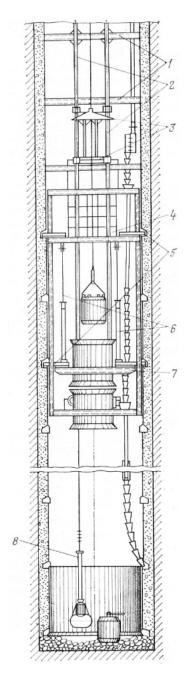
Схема проходки с одновременным армированием: 1 – расстрелы; 2 – проводники; 3 – направляющая рамка; 4 – полок; 5 – выдвинутые опоры полка; 6 – гидродомкраты перемещения полка; 7 – подвижной этаж полка; 8 – опалу бка
